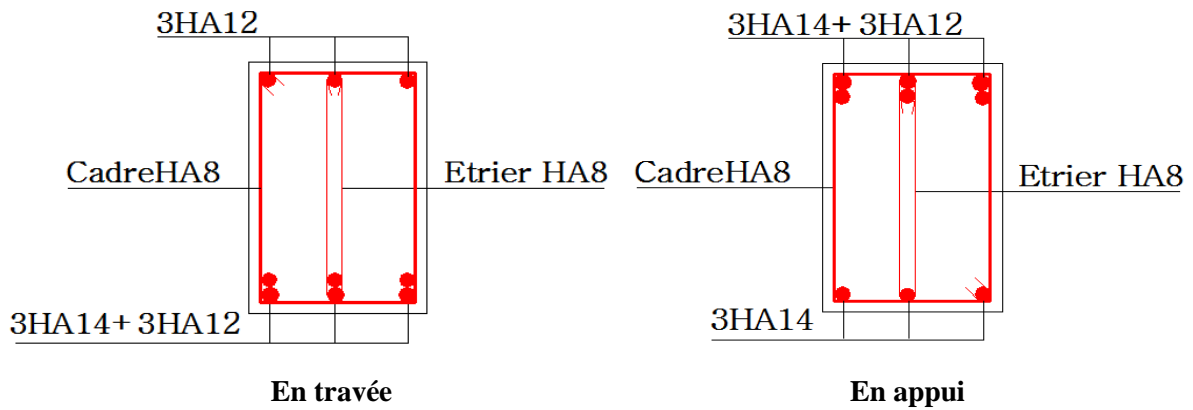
Schémas de ferrailage des poutres principales étages courants.
